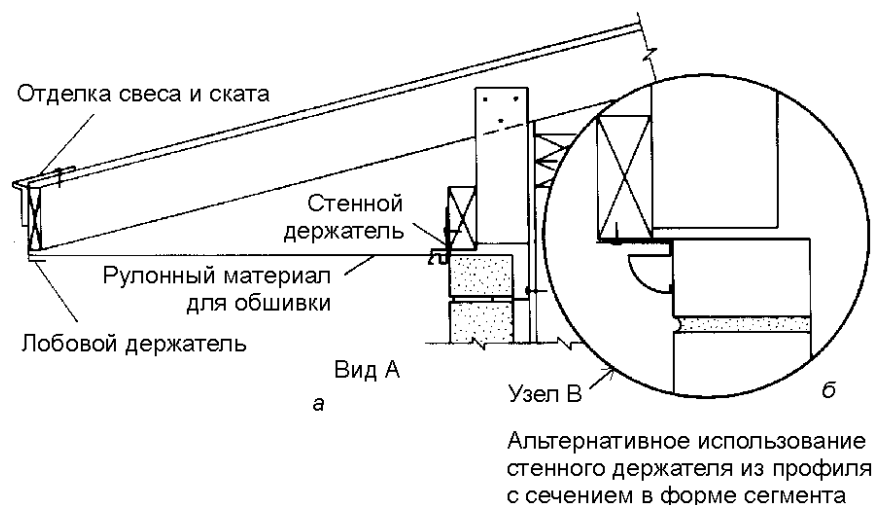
Крепление софита к стене, облицованной кирпичом:
